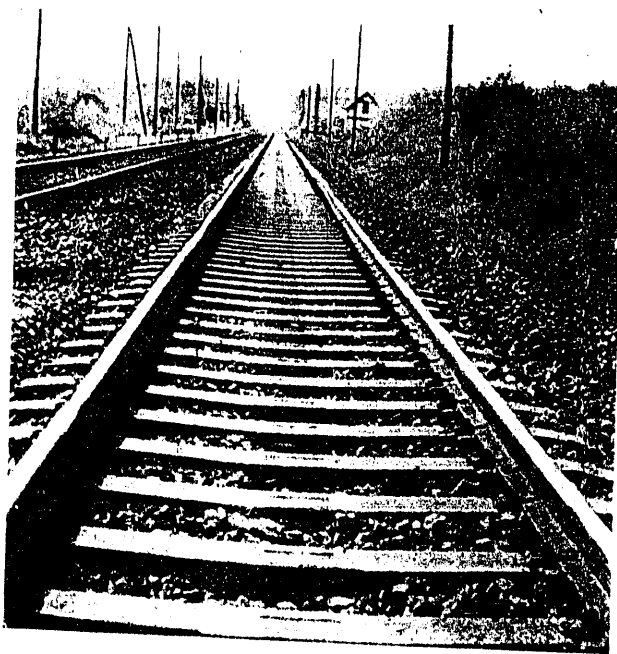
ª — Barras largas (carril de 800 m.) sobre traviesas de hormigón pretensado.
